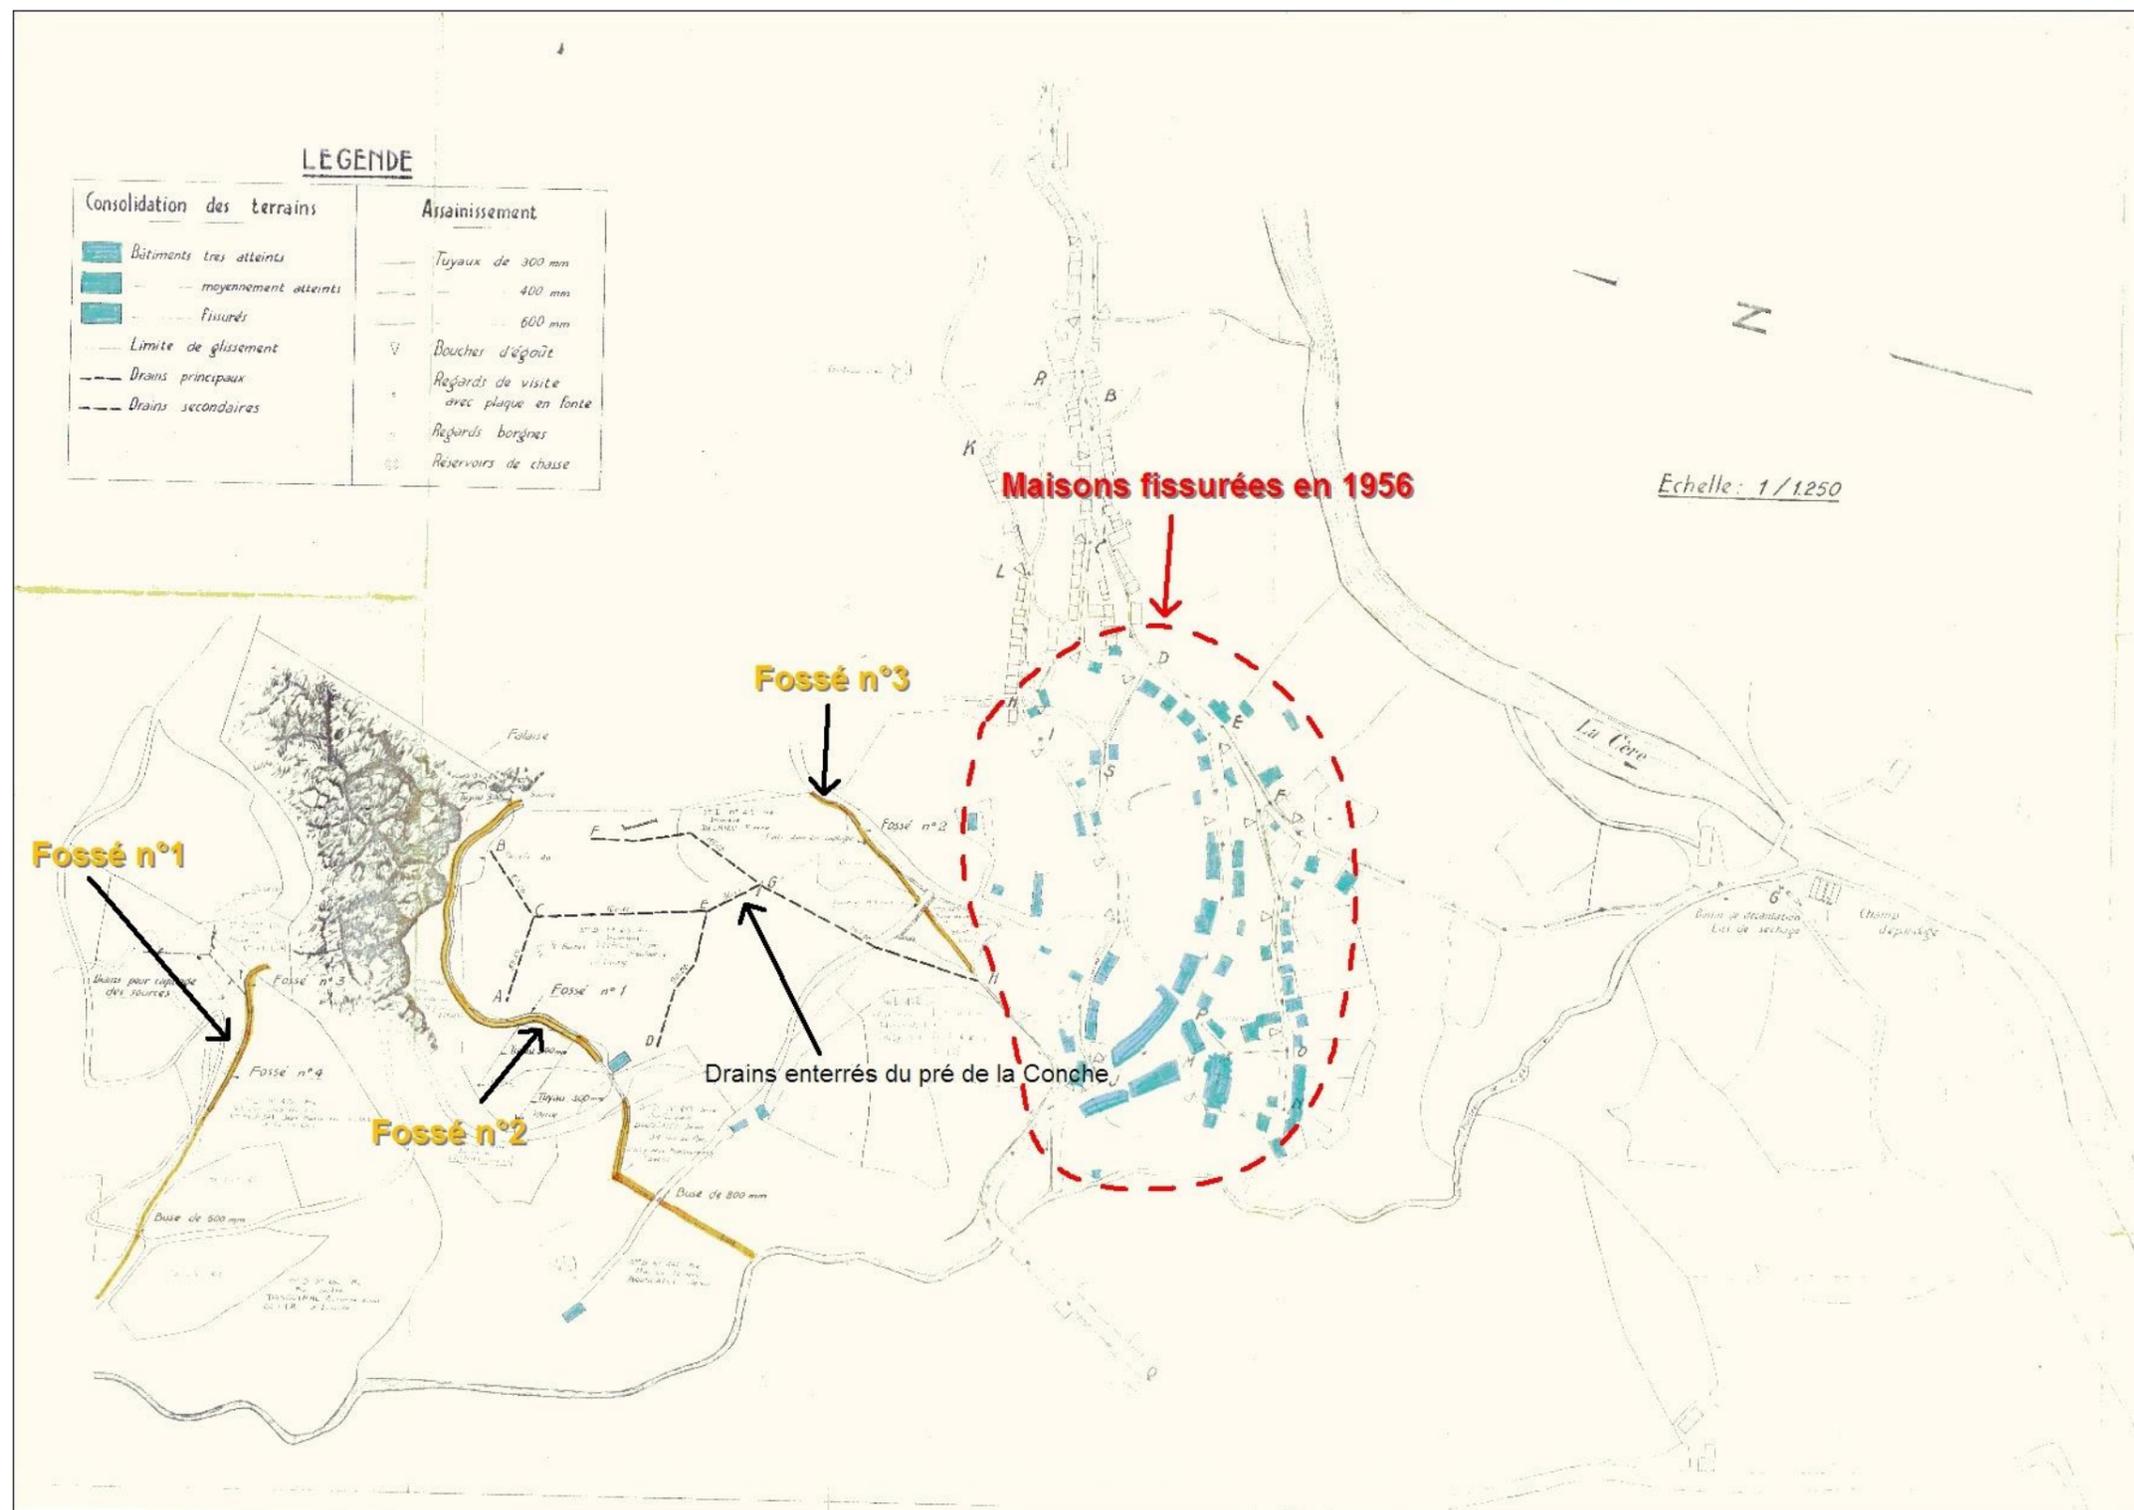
Travaux de drainage effectués en 1956-57 sur le glissement de Thiézac
